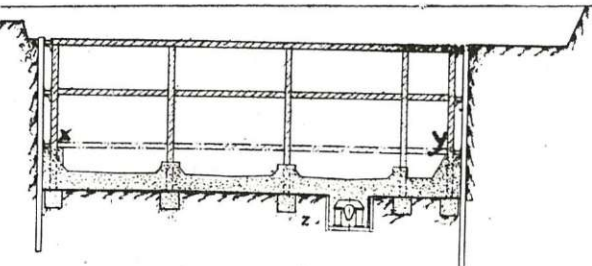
a) Ferrailage et bétonnage de l'égout-drain Z; b) Bétonnage du radier du tunnel, des pieds-droits et des colonnes du tunnel jusqu'au niveau de l'étaçon intermédiaire X-Y.
